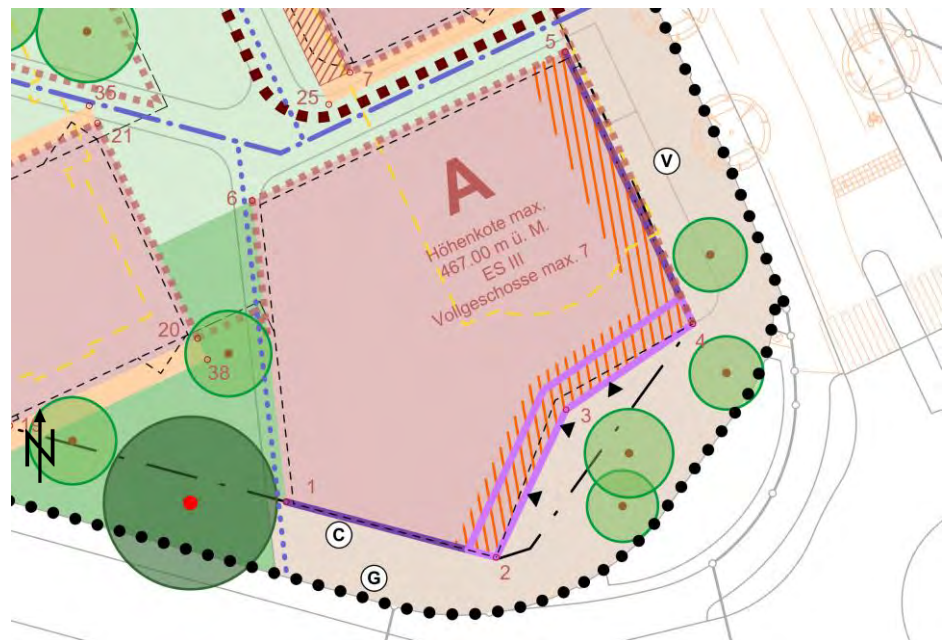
Ausschnitt Gestaltungsplan, dat. 15.12.2025
